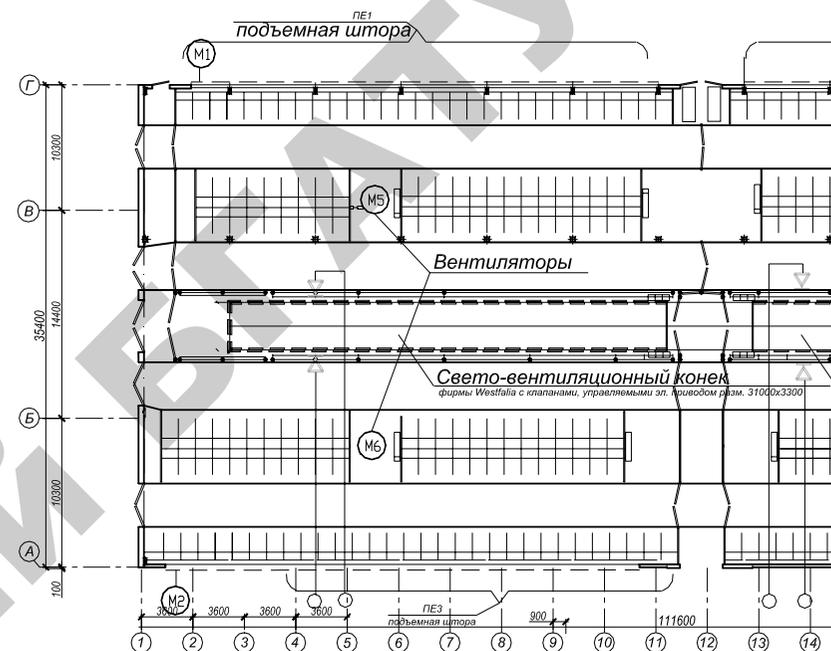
Часть здания фермы КРС с расположением вентиляционного оборудования
